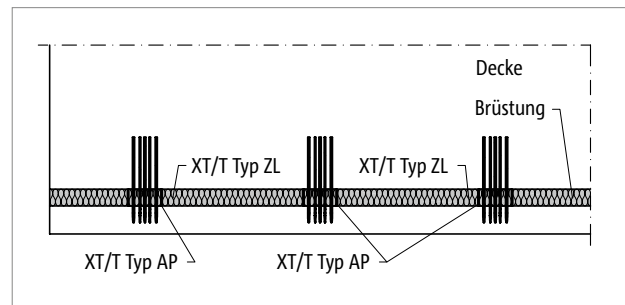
Schöck Isokorb® XT/T Typ AP horizontale Anordnung: Ansicht Brüstung vorgesetzt
